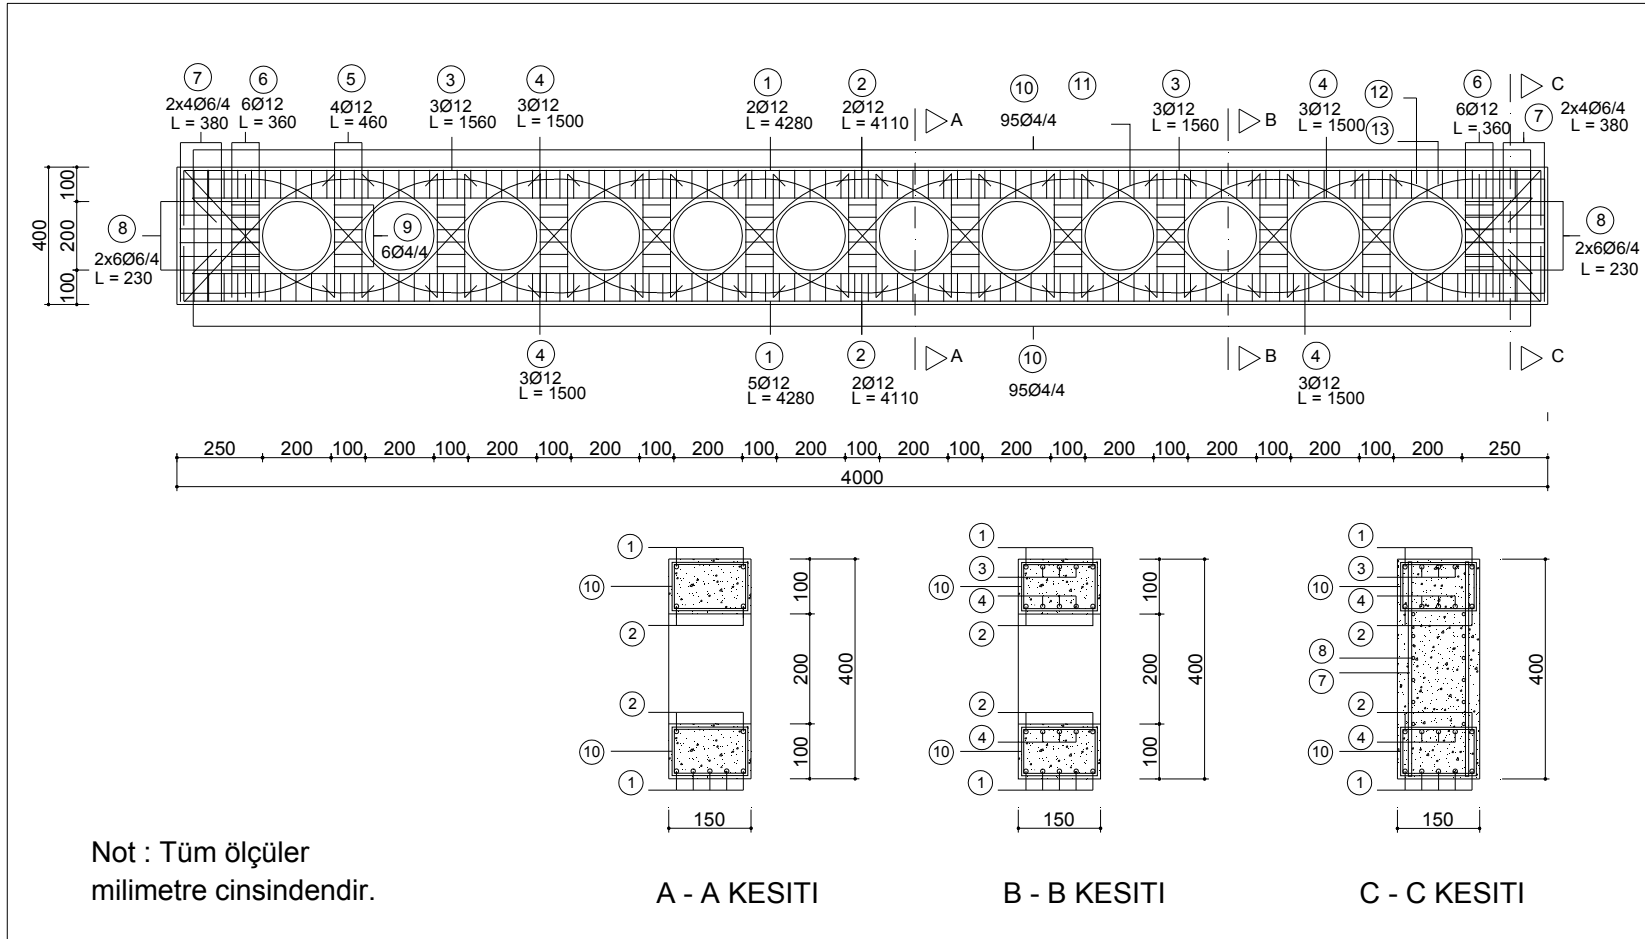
RCxb kiriş donatı planı ve kesitleri
